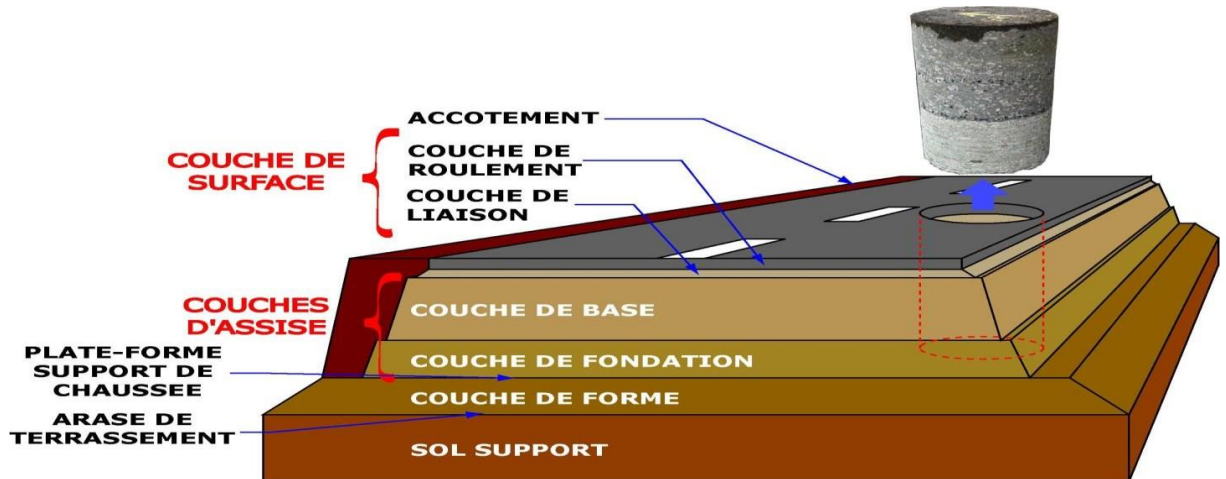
Constitution d'une structure de chaussée souple [12].
